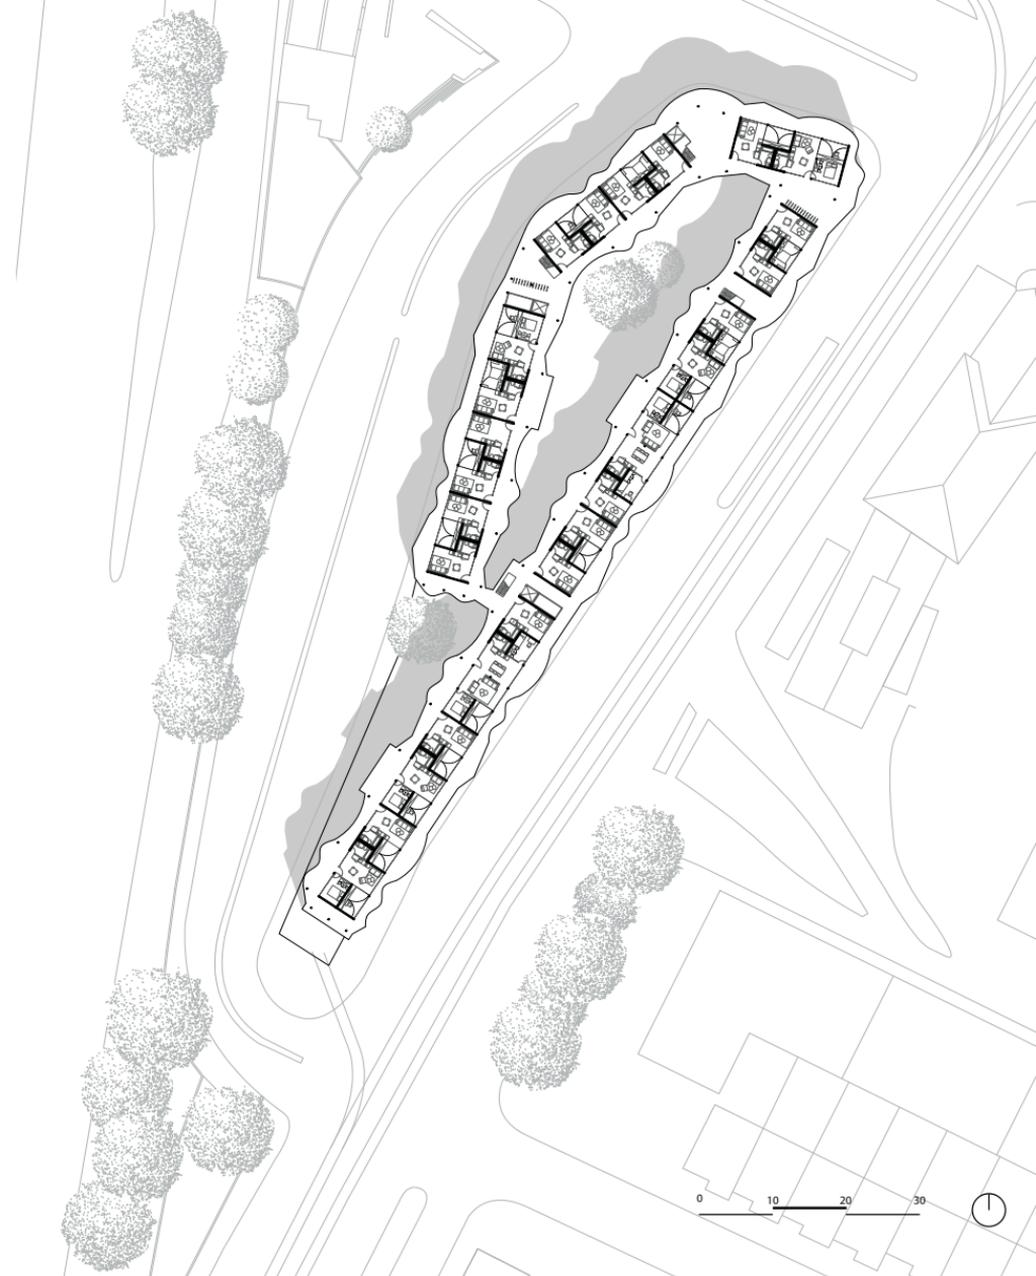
Plan d'étage courant sur le site du Upper Yard Park
